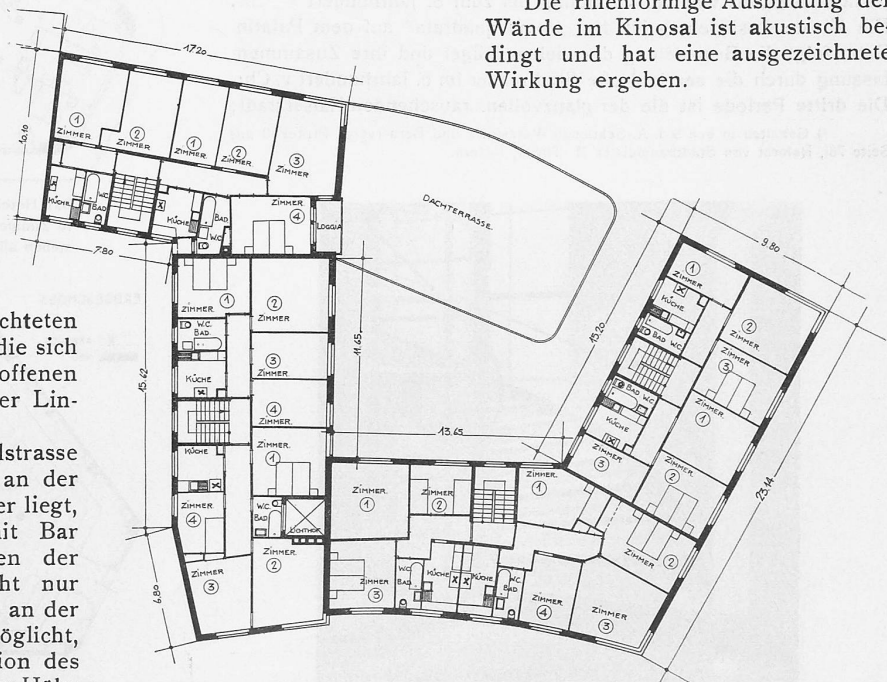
Grundriss der Wohnungsgeschosse. — Masstab 1 : 400.
